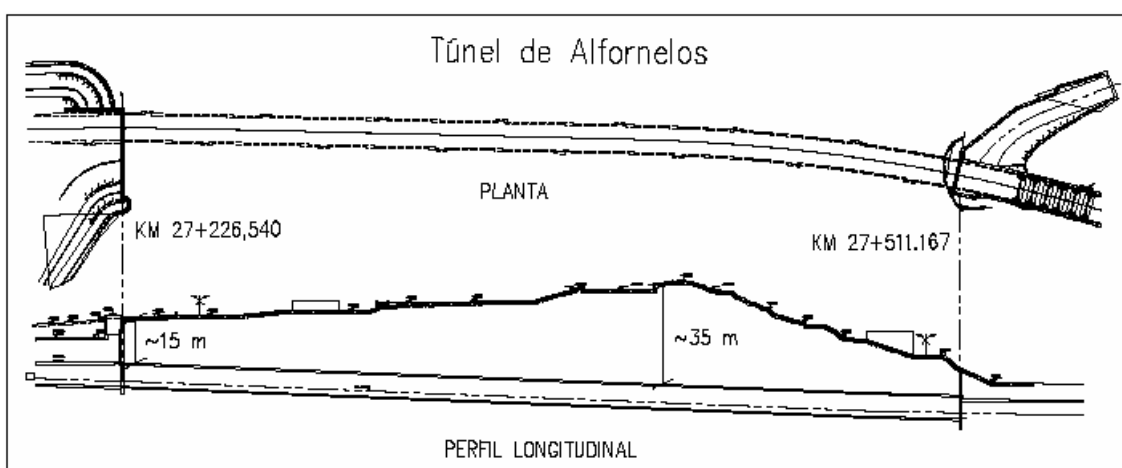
Túnel de Alfoanelos. Planta e perfil longitudinal. (Melâneo *et al.*, 2004b)
